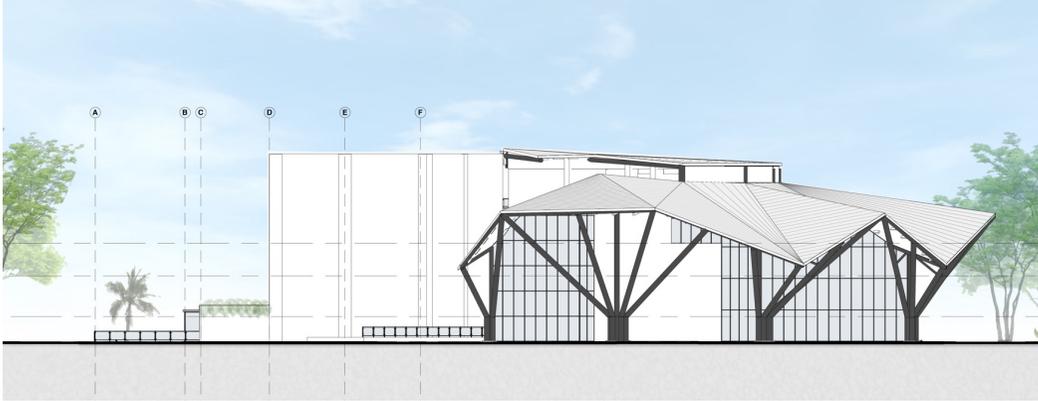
Collage elevación y perspectivas fachadas laterales.
